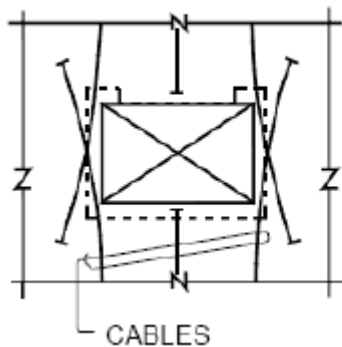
a. Disposición de cables inhibidora de la fisuración. [A2]
